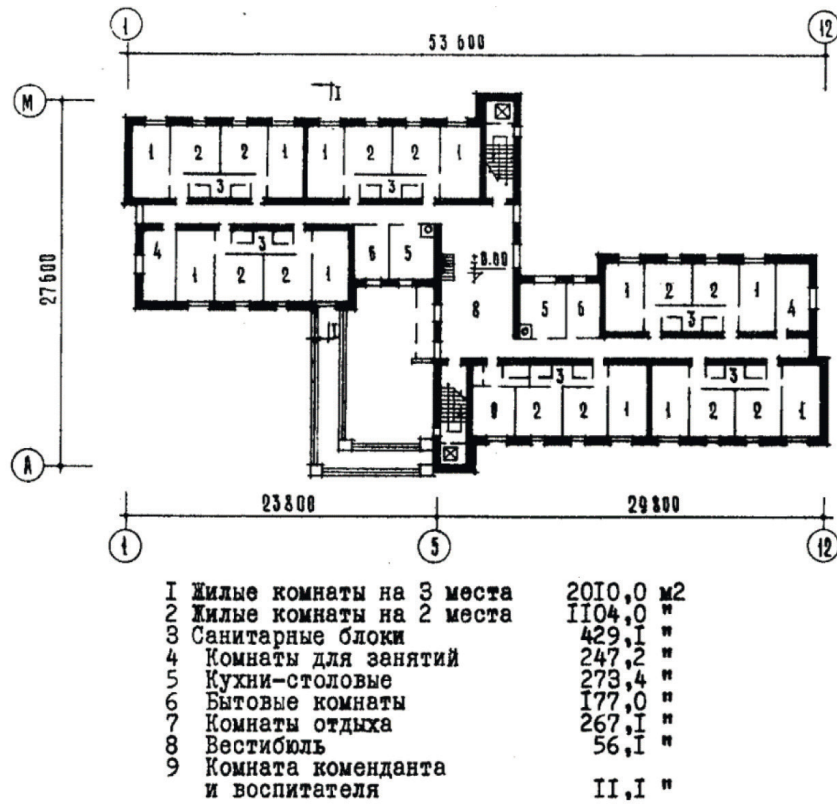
Plan du rez-de-chaussée avec liste des pièces principales
